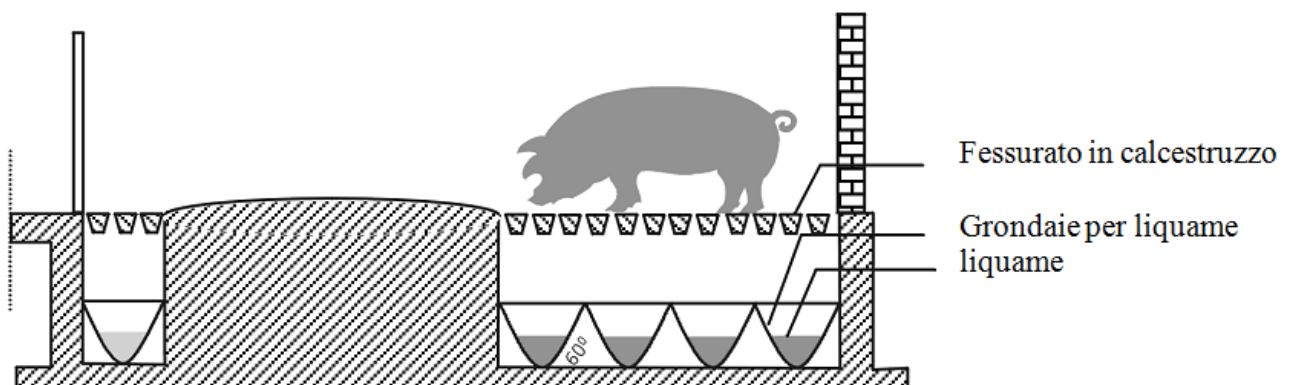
Pavimento parzialmente fessurato convesso in combinazione con canalette raccolta liquame
